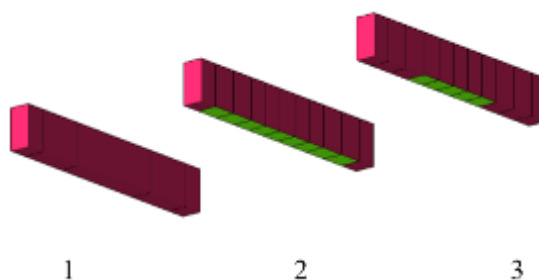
Расчетная модель железобетонной балки: 1 – железобетонная балка без усиления; 2 – железобетонная балка, усиленная в растянутой зоне углеволоконным холстом по всей расчетной длине; 3 – железобетонная балка, усиленная углеволокном в середине пролета растянутой зоны (условие закрепления по торцам холста анкерными жгутами)
